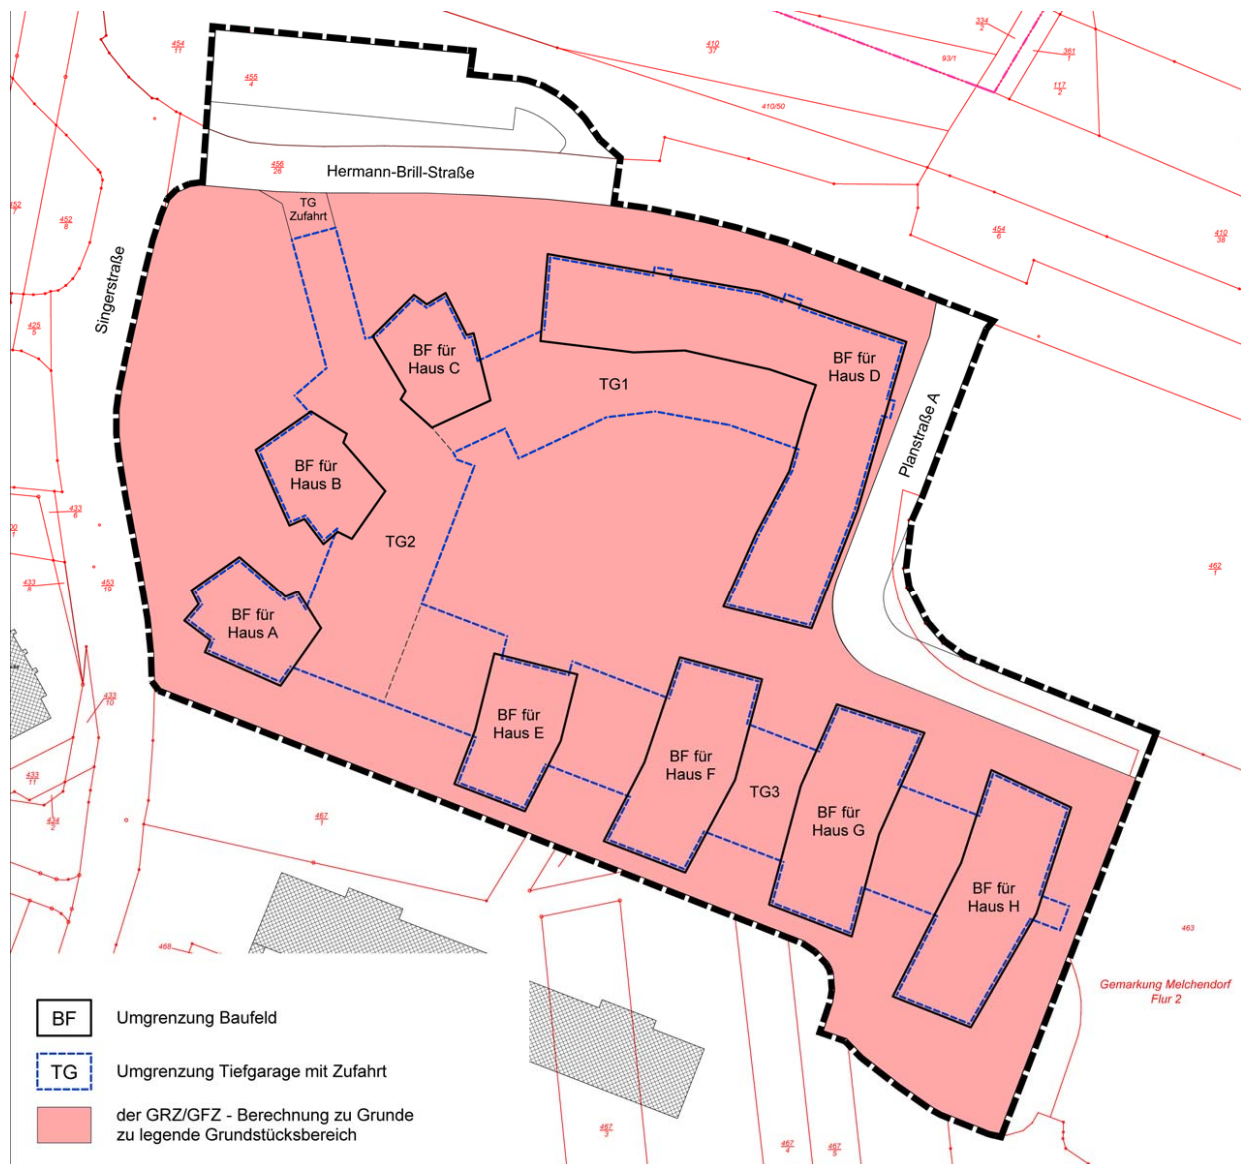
Lageplan mit Darstellung der Baufelder und der Grundstücksfläche, die der Berechnung der GRZ und GFZ zu Grunde zu legen ist, Entwurfsverfasser Henchion Reuter Architekten Berlin
